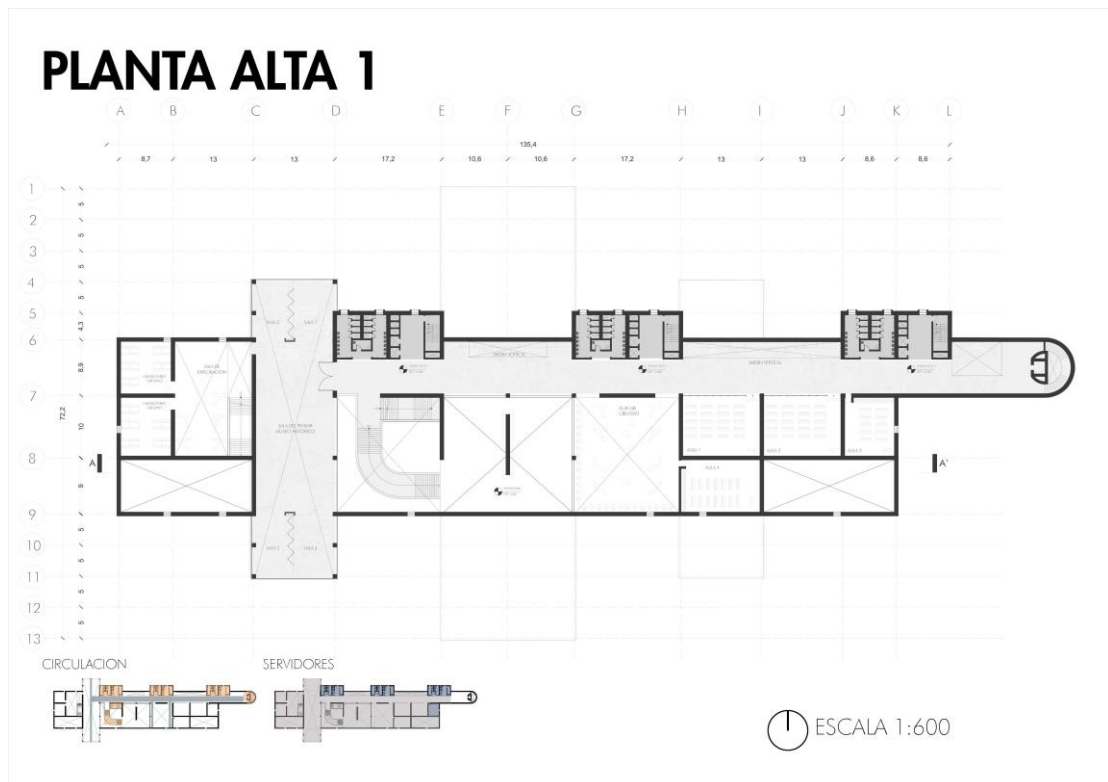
Planta Alta 1 Nivel +4.80 m Fuente: Autor
